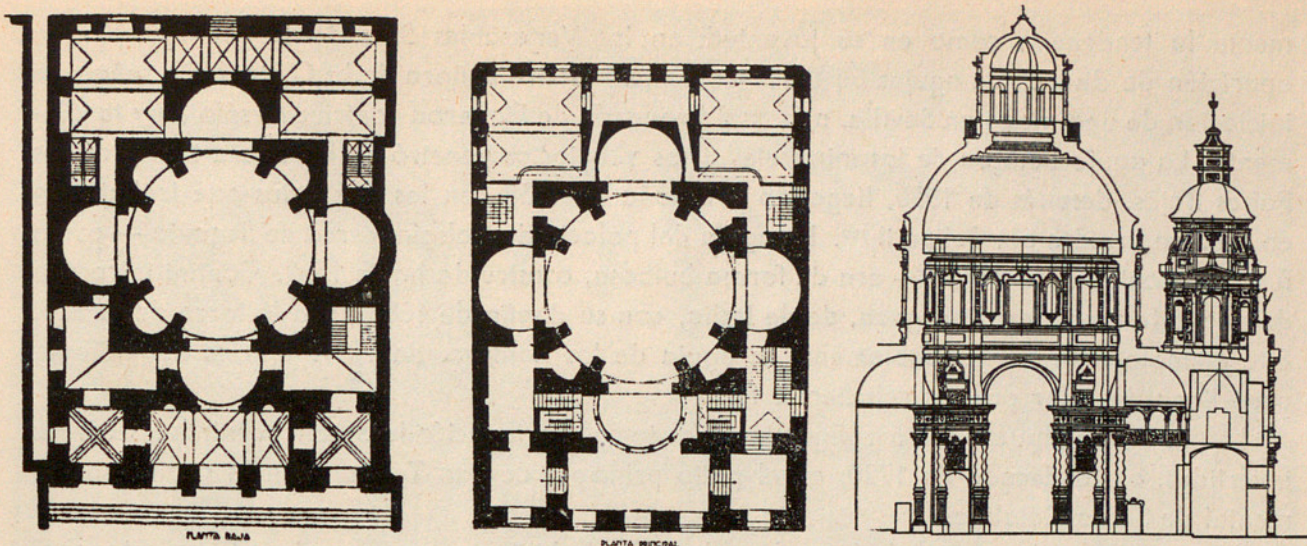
PLANTAS BAJA Y PRINCIPAL Y SECCIÓN DE LA IGLESIA DE SAN LUIS, EN SEVILLA. Según Sancho Corbacho.
